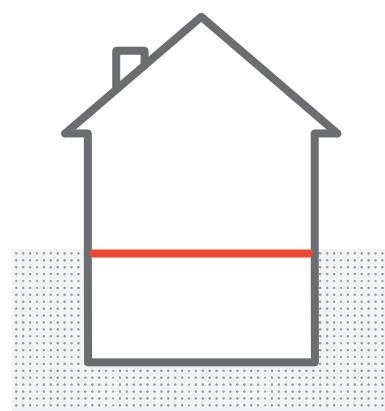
Colocación de la barrera en el cerramiento entre el sótano y la planta baja
